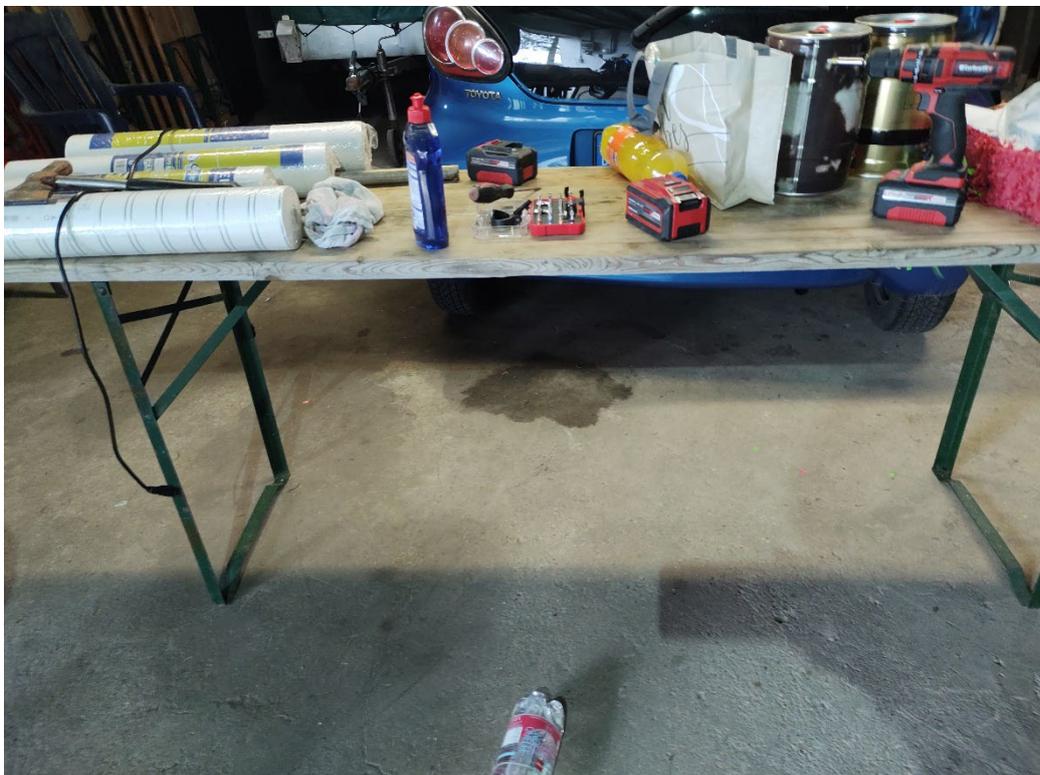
Ölverunreinigung der Betonplatte bei Bohrung RKS 1
